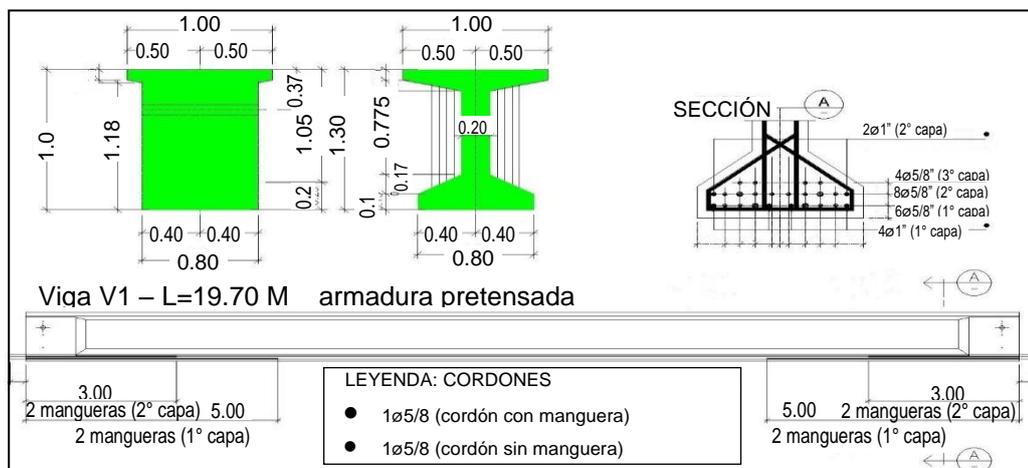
Geometría típica para viga prefabricada H=1.30m
